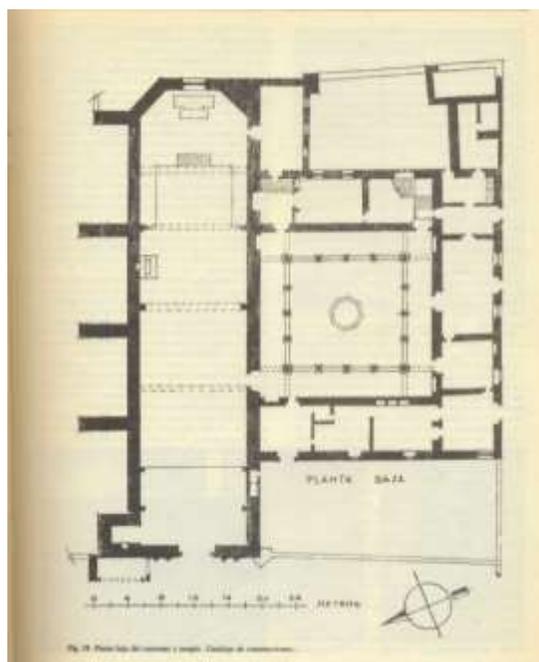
Planta esquemática ex convento de San Andrés, Epazoyucan.
